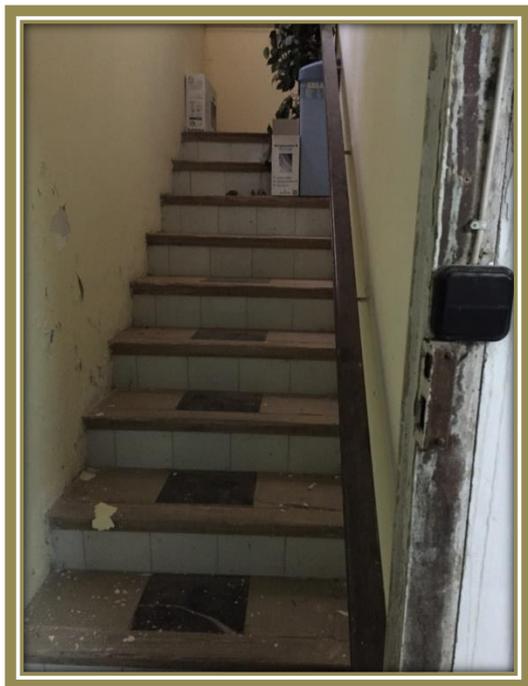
Tomada desde la escalera de Planta Sótano.
